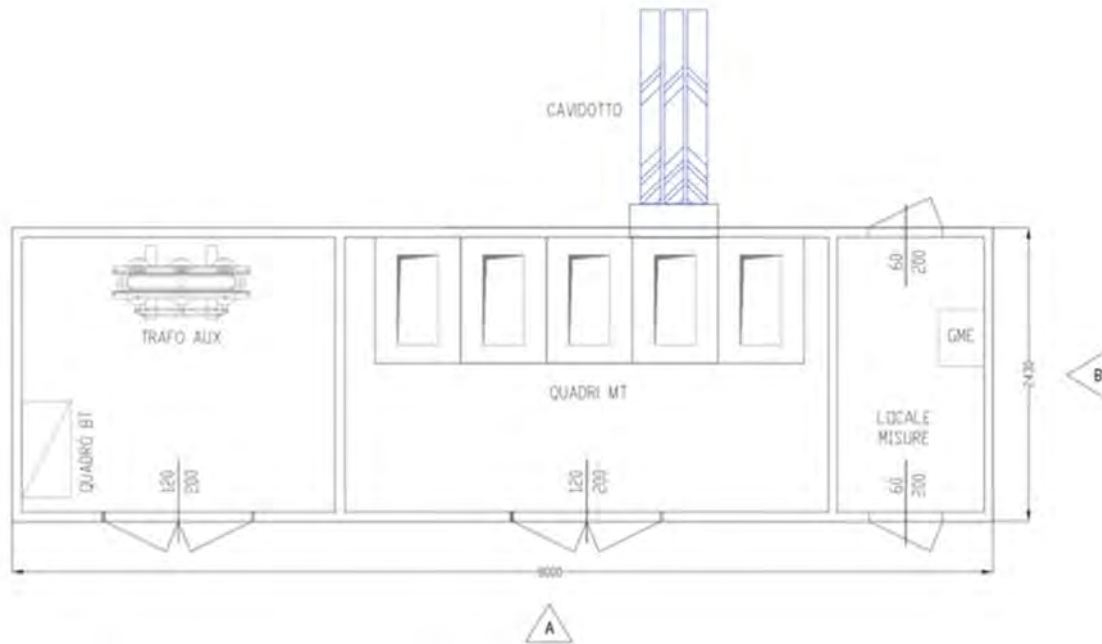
Locale cabina di Parallelo MT-Prospetto
